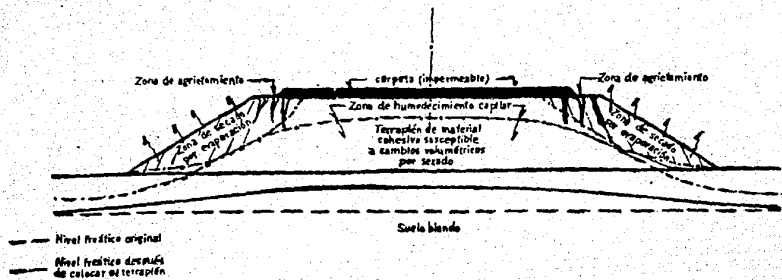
Mecanismo del agrietamiento longitudinal de terraplenes
